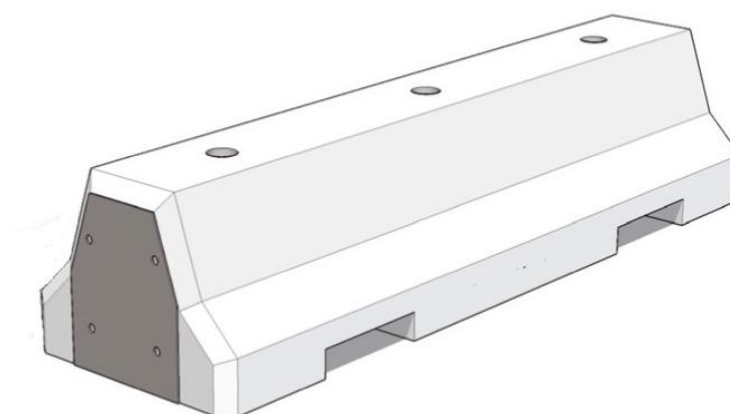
Modello di un elemento di tipo “New Jersey”
